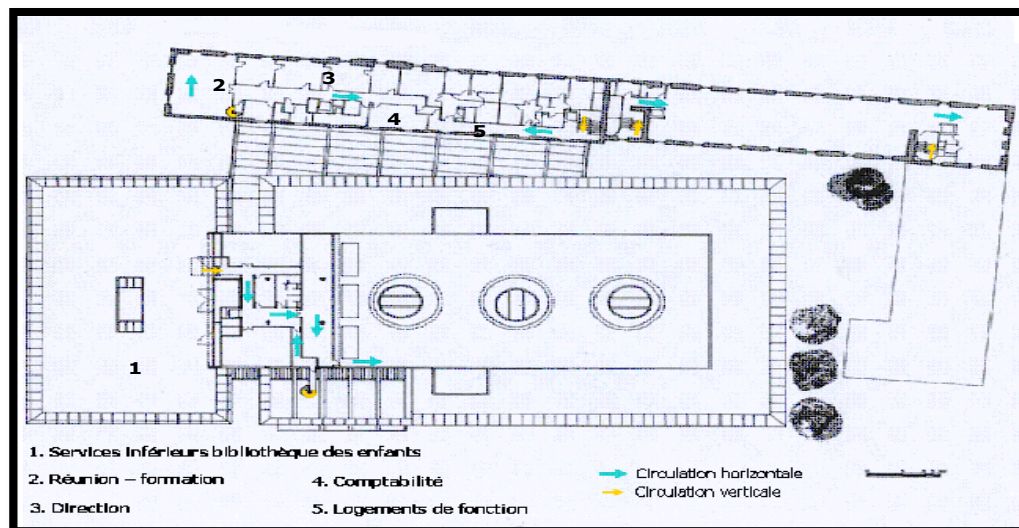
PLAN 2ème étage (source : Pierre Riboulet)
